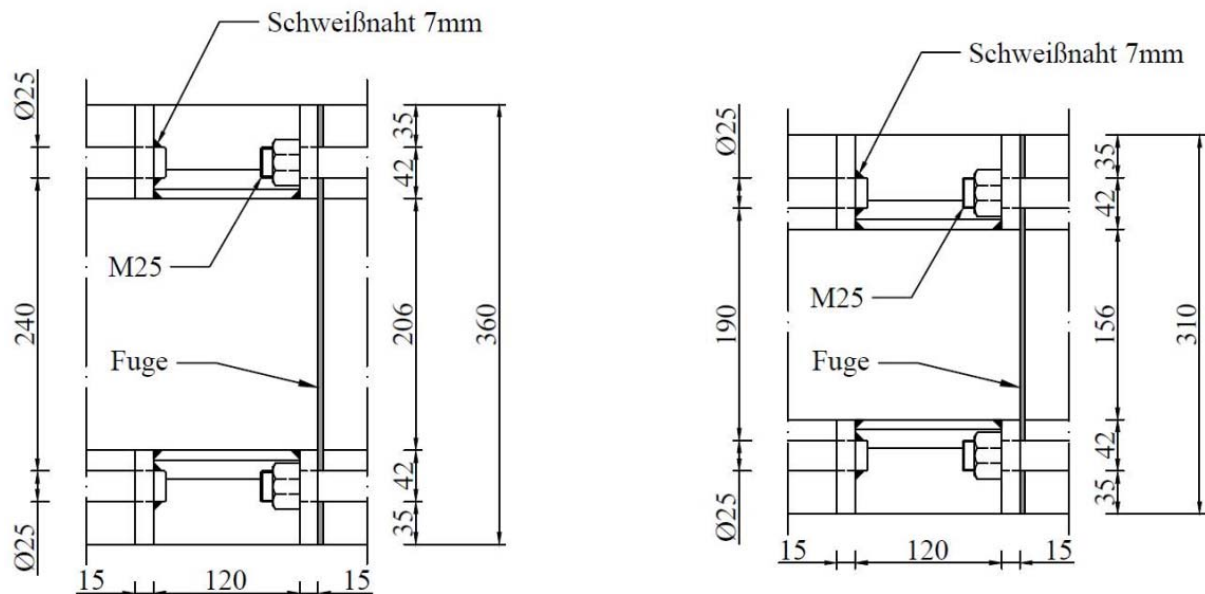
Horizontalschnitt (links) und Längsschnitt (rechts) des Anschlussdetails
